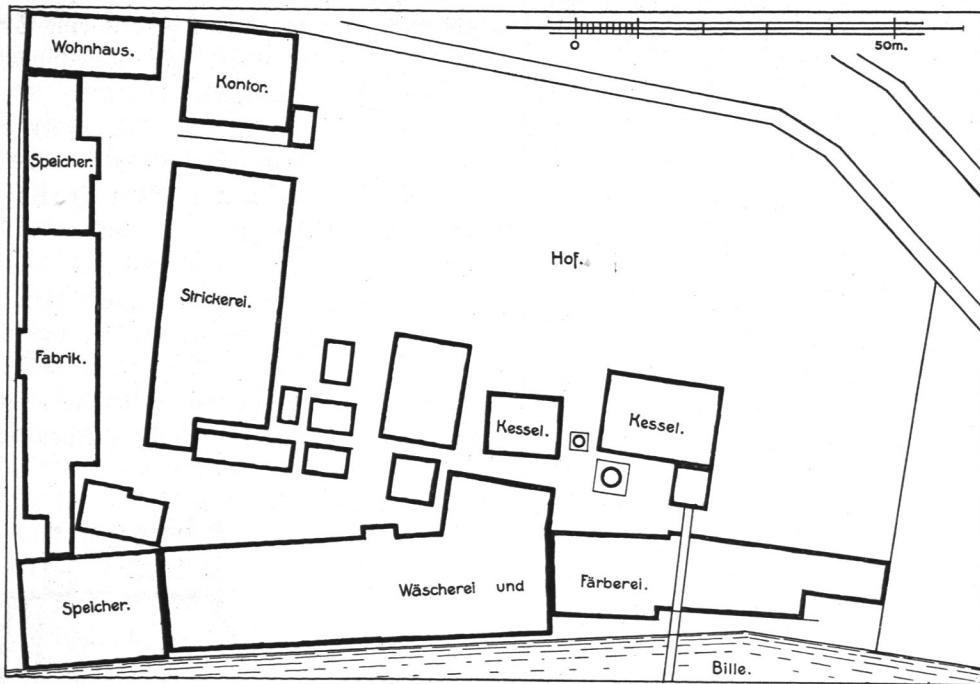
Bifchoff & Rodag, G. m. b. H., Lageplan.
